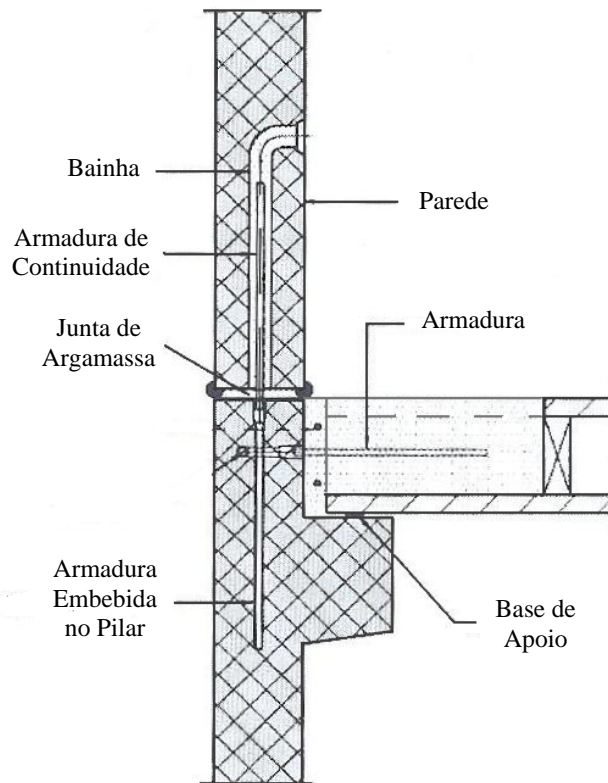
Ligação parede - parede - laje com armaduras de continuidade, adaptado de [6]
